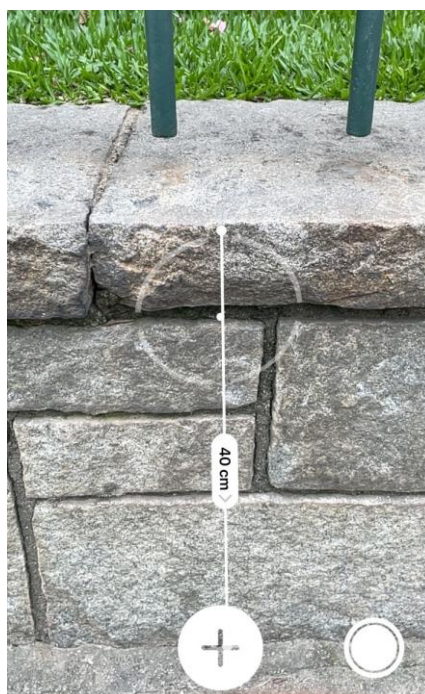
Medição do desnível entre a calçada e edificações nível da mureta externa da edificação. Fonte: Autora
